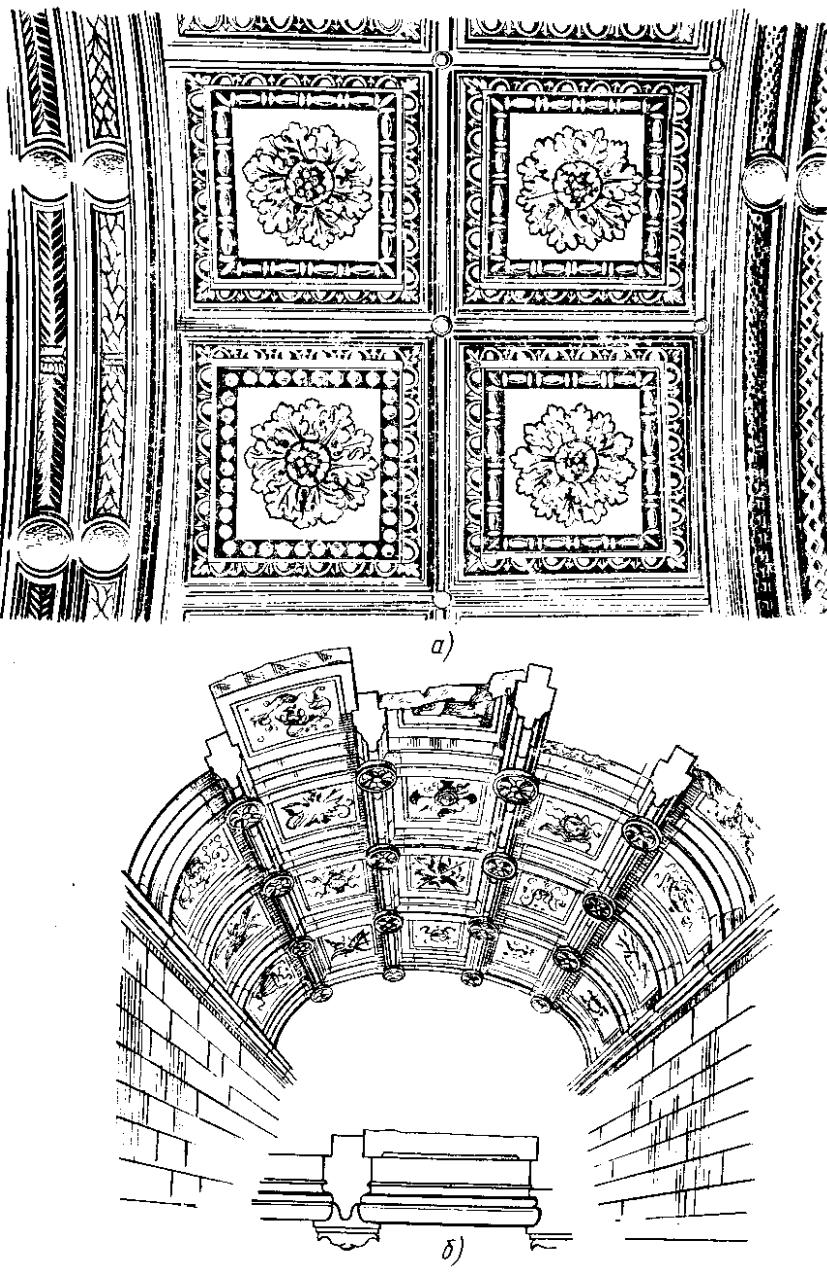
Пример укладки кессонных плит по подпружным аркам (фрагмент свода капеллы Пazzi во Флоренции) (а) и по ребристой решетке каркаса (реконструкция) (б)
